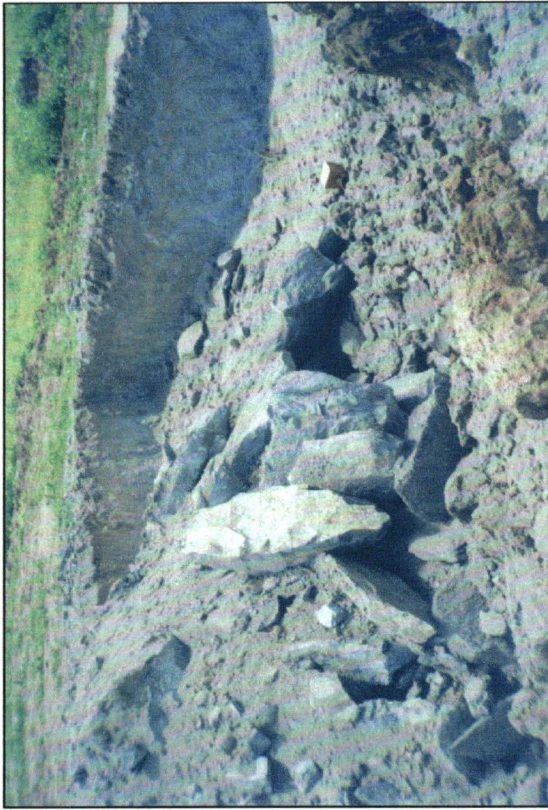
Escavação na rocha do poço de captação da adutora.
